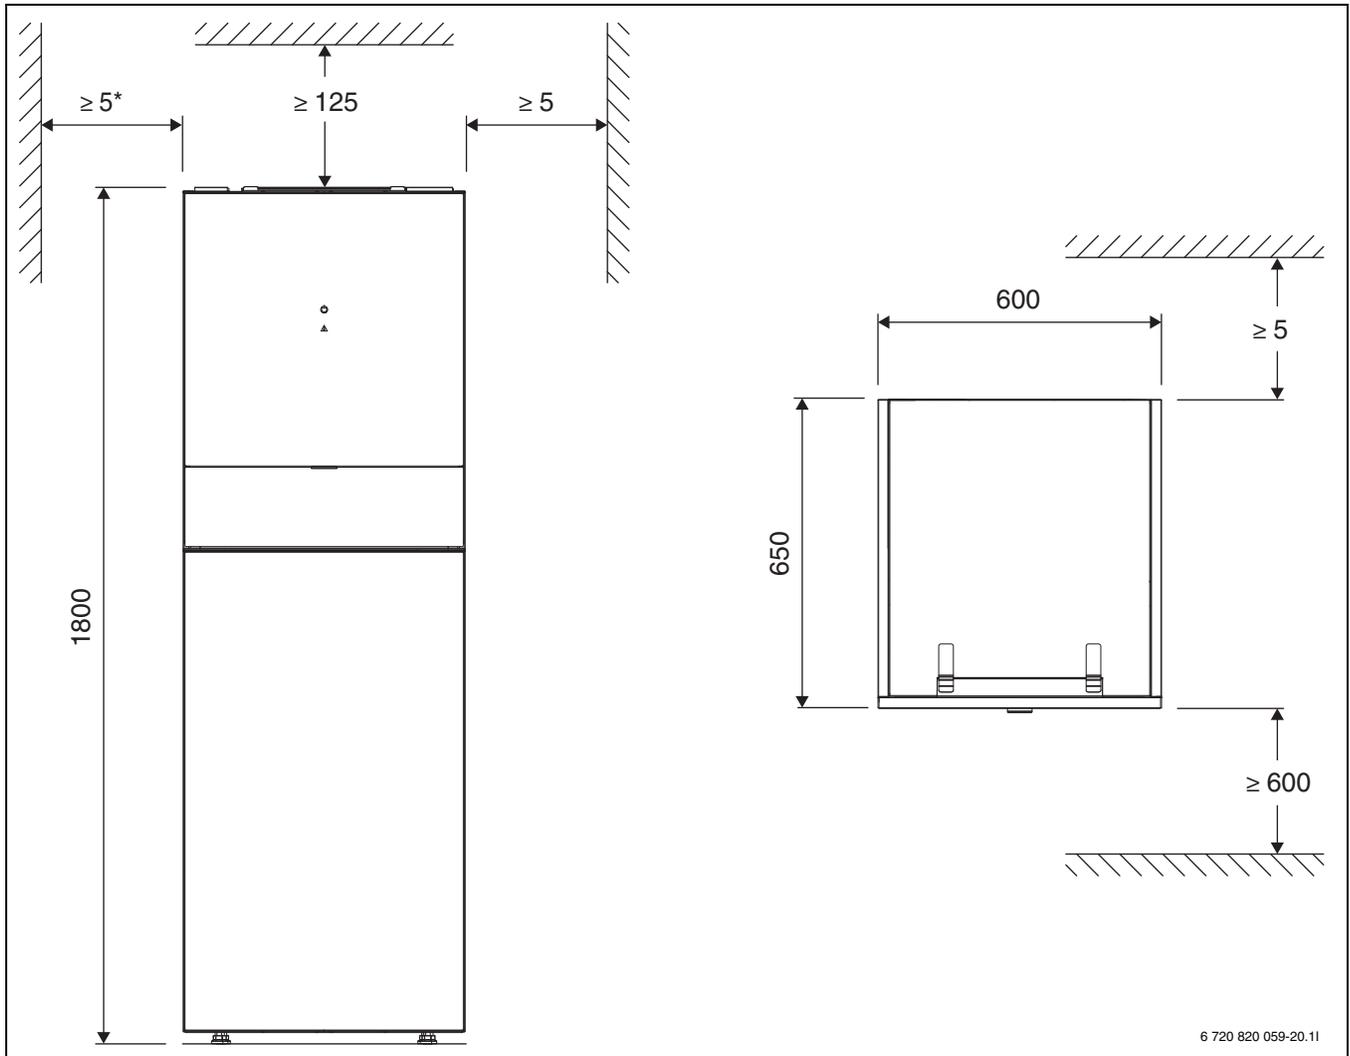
Abmessungen und empfohlene Mindestabstände, Frontal- und Draufsicht
